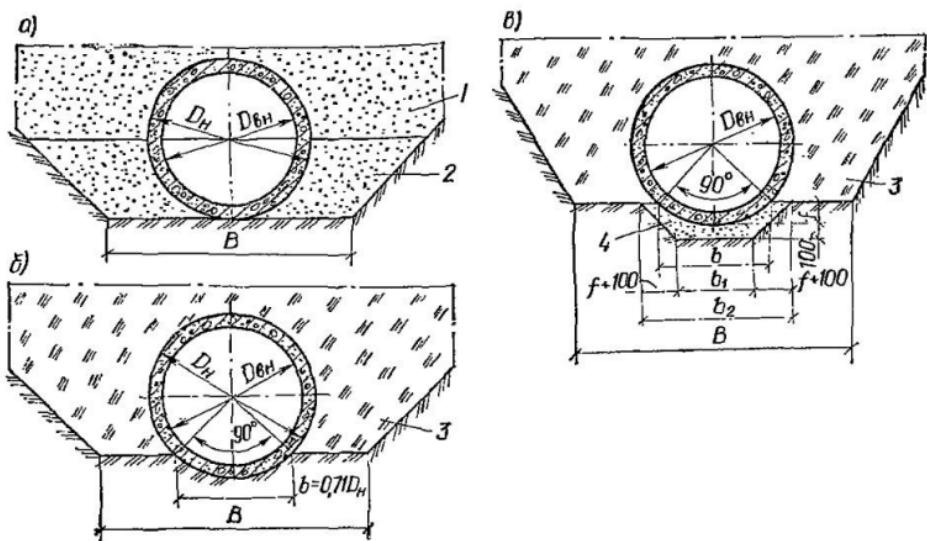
Укладка трубопроводов $D_{BH}=600\div 2500$ мм на основание
